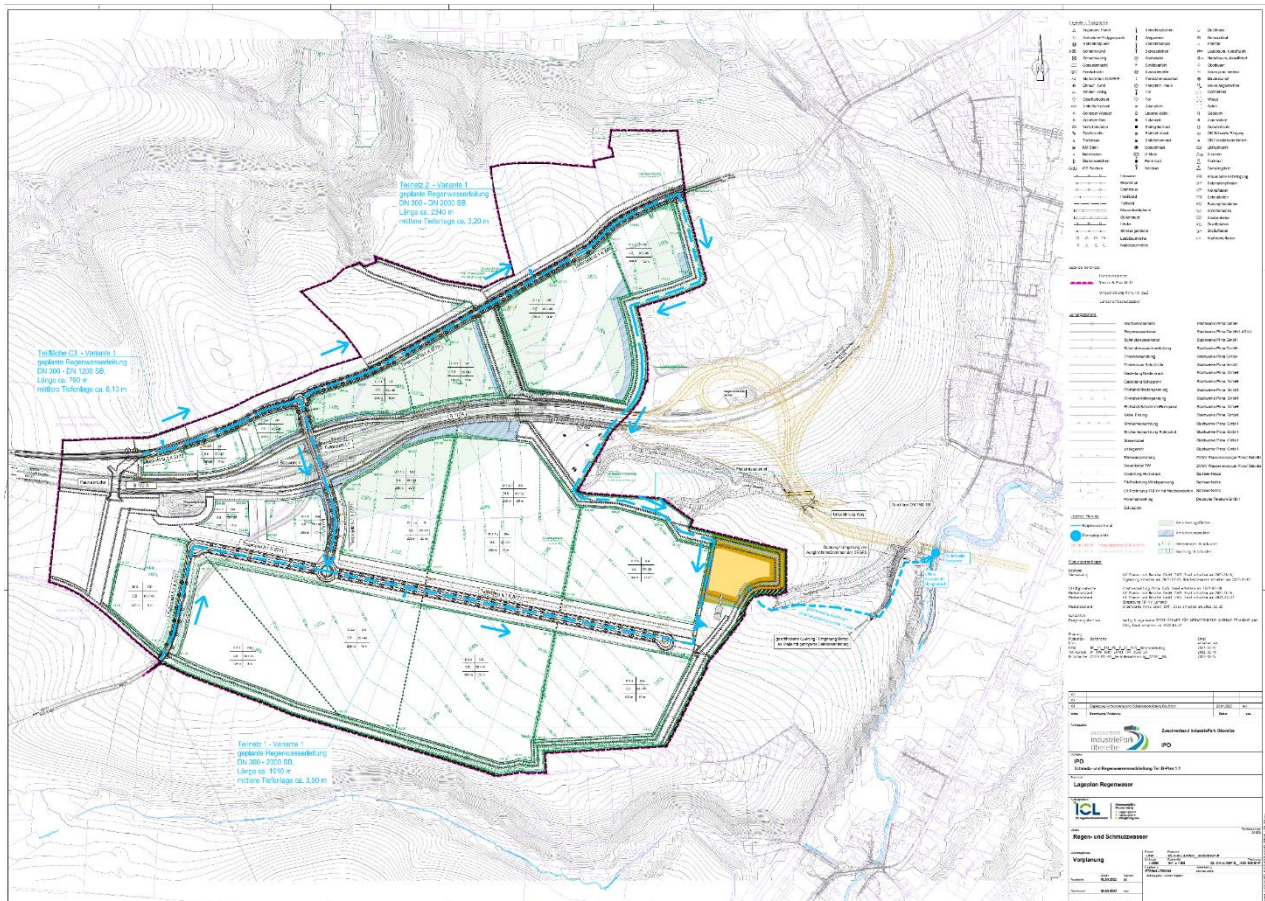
Lageplan Niederschlag mit Leitungssträngen, Versickerungsmulden, RRB sowie Leitung mit Einleitstelle in die Seidewitz /9/
